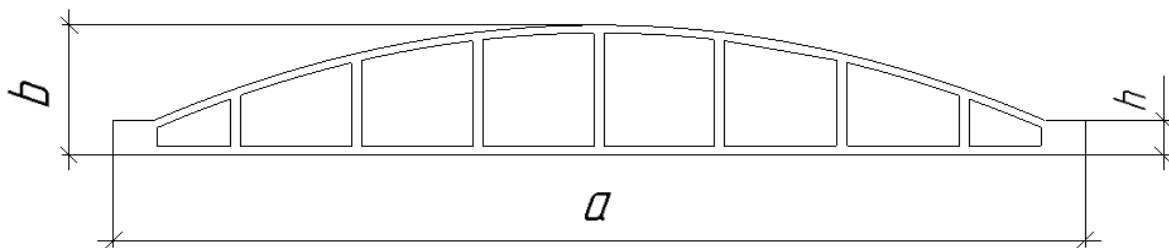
Залізобетонні ферми згідно ДСТУ Б В.2.6-118:2010
